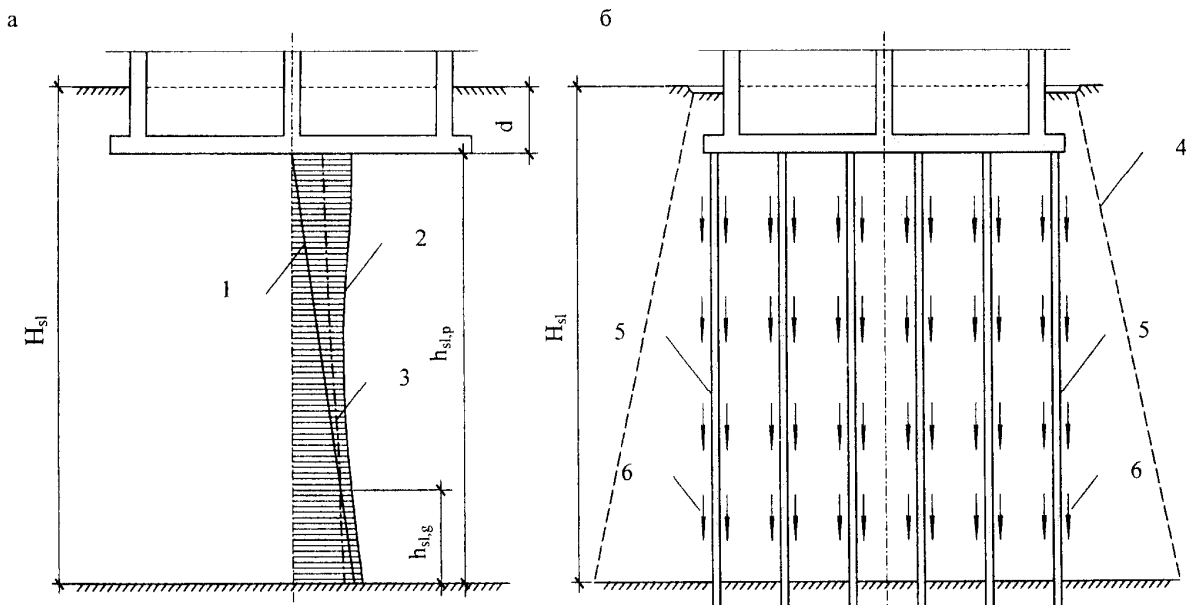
Схеми до розрахунку основи типу Б (плитні фундаменти)
